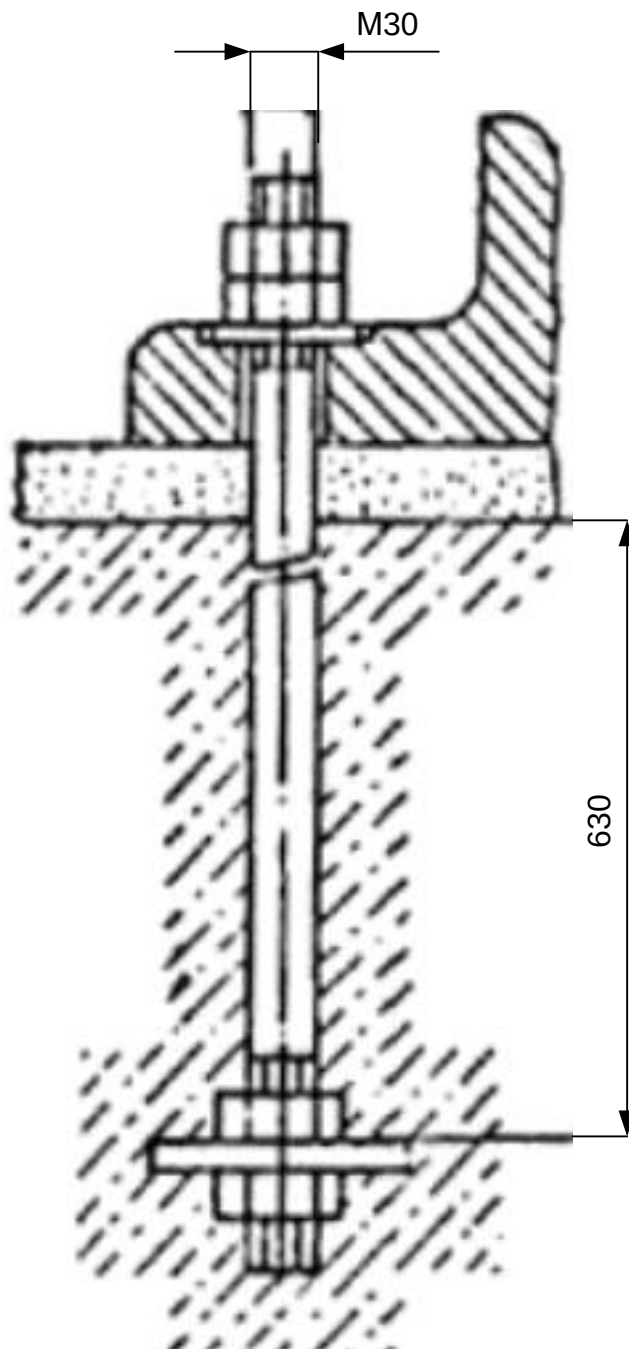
Эскиз заделки фундаментного болта с анкерной плитой
